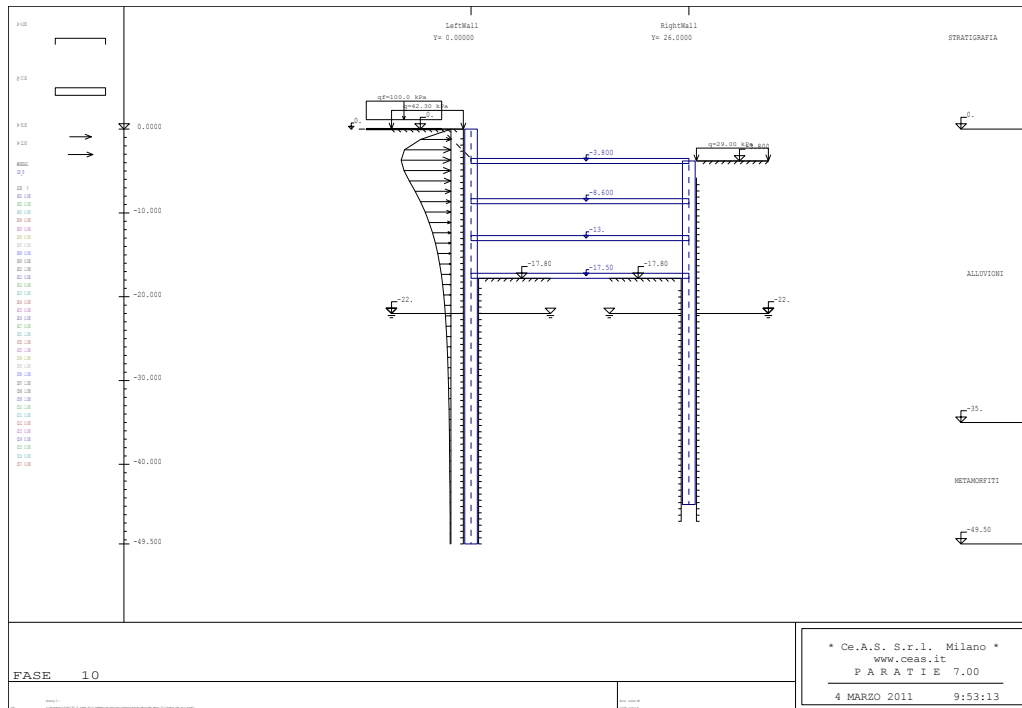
Fase 10: Getto Solai +32.84m s.l.m.
